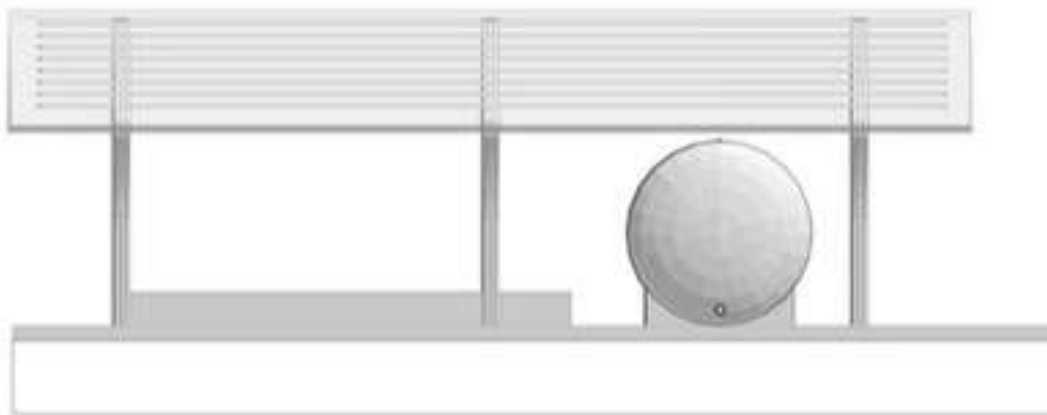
DETAIL SISTEM PENGOLAH LIMBAH BATIK
